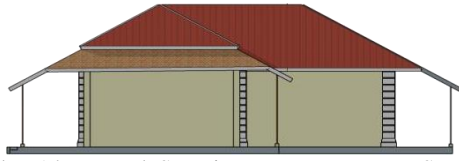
Tampak Belakang Bangunan SMPN 16
